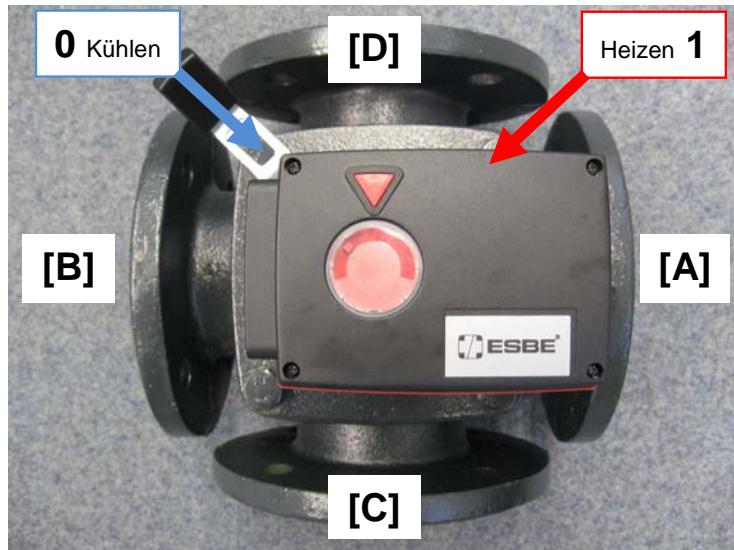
Ansicht 4-Wege-Ventil mit Beschriftung der Anschlüsse
